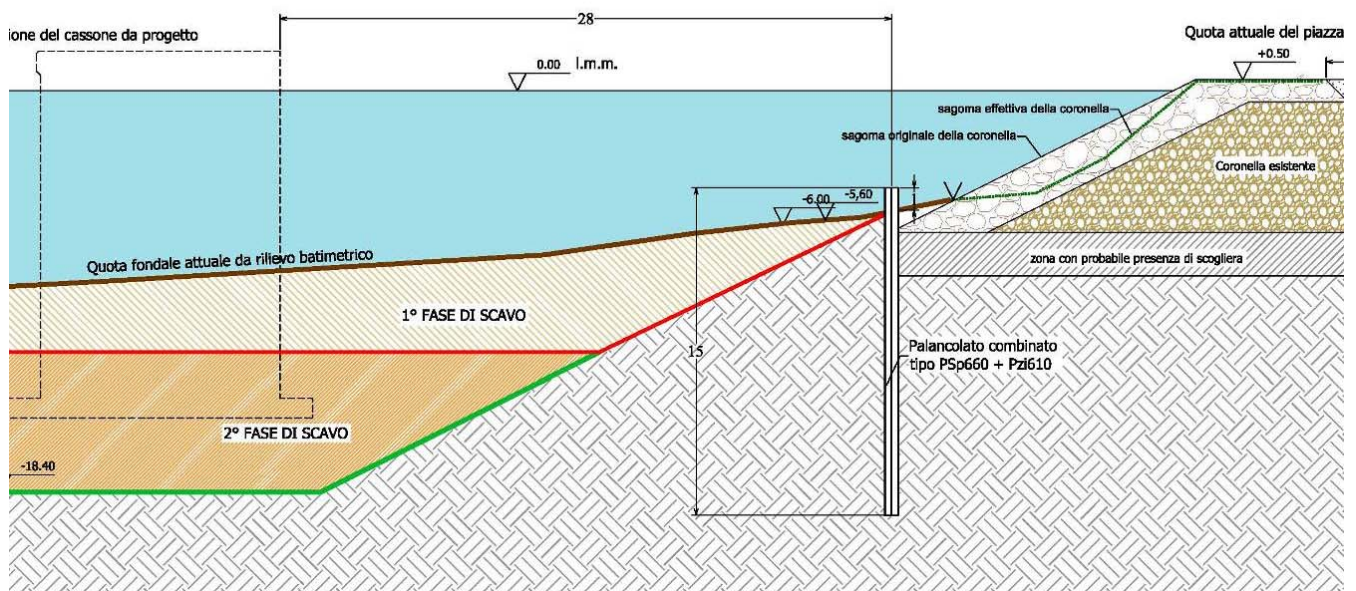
Dettaglio sezione scavi e posizionamento palancolato
